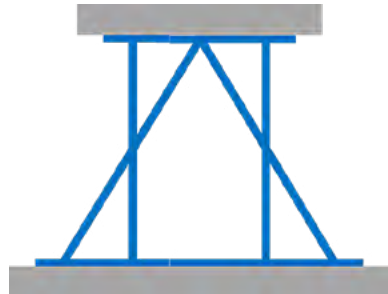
Aussteifung eines Flächenfachwerks mit einer A-Verstrebung
